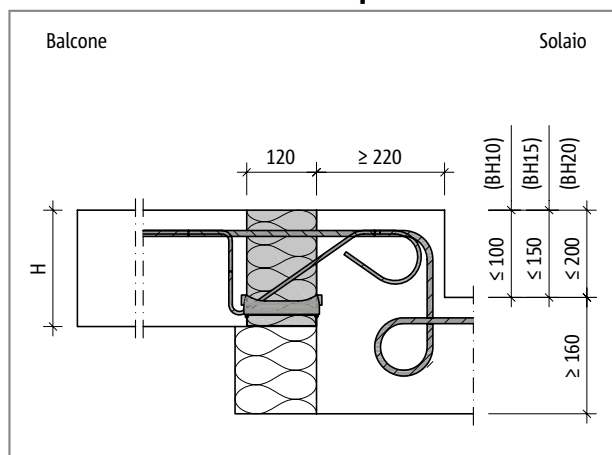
Schöck Isokorb® tipo KXT-BH: balcone con innalzamento di quota e isolamento esterno
